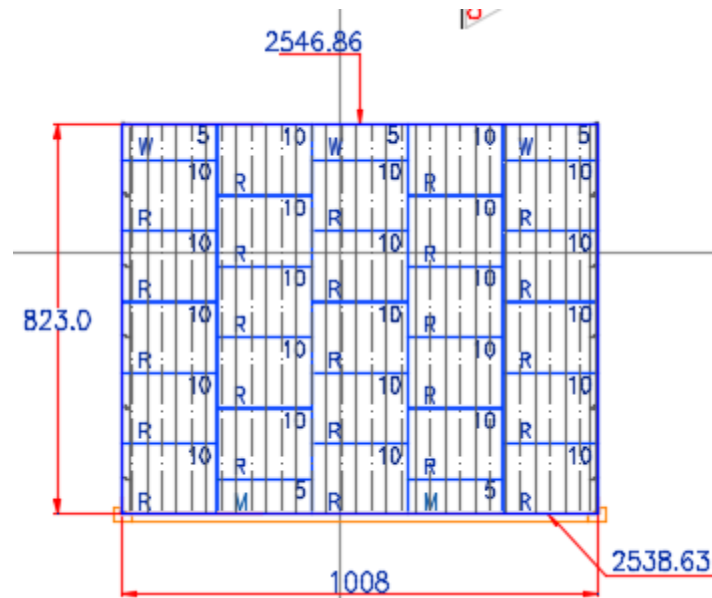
Viga solera muro en tierra armada sobre el eje 5. (Autor)
